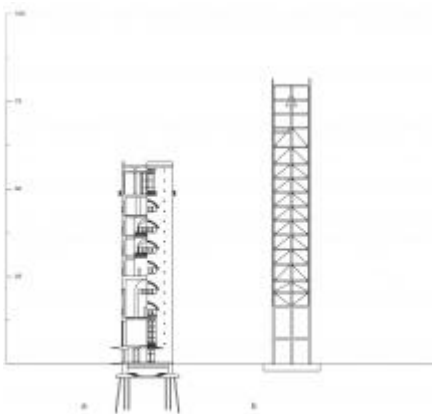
a) Hauptbahnhof Stuttgart, Turm des Empfangsgebäudes mit 56,90 m Höhe und b) Glockenturm der Olympiade Berlin 1936 mit Glockenstuhl (12,50 m Höhe), Stahlkonstruktion (48,76 m Höhe) und Stahlbetonkasten an der Basis mit 17,80 m Höhe (nach Drechsel [30, 50])
